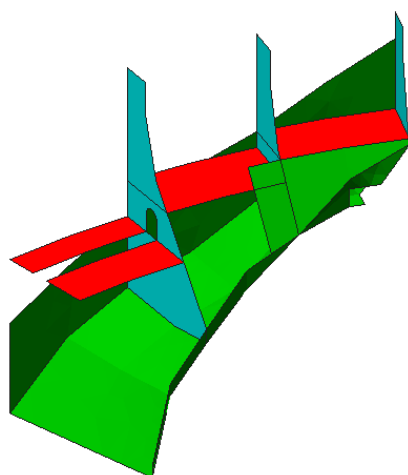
Planos de juntas entre la presa y el terreno (verde), entre bloques (azul) y entre los hormigones de 1ª y 2ª fase (rojo).
